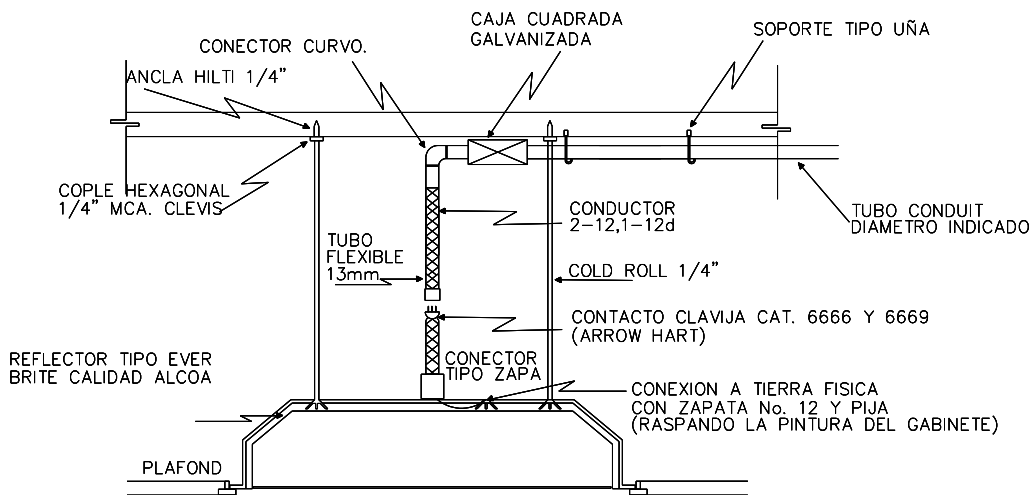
Detalle para la colocación de luminarias de 60 x 60 cm.
